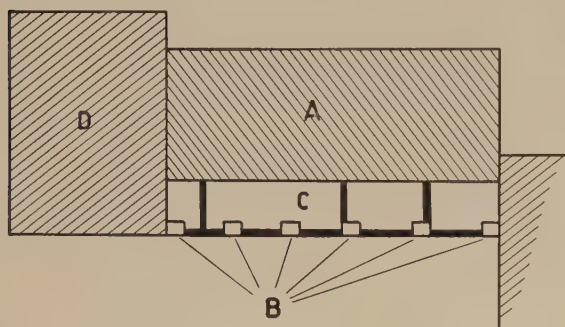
Schema planimetrico della costruzione con le fabbriche addossate
